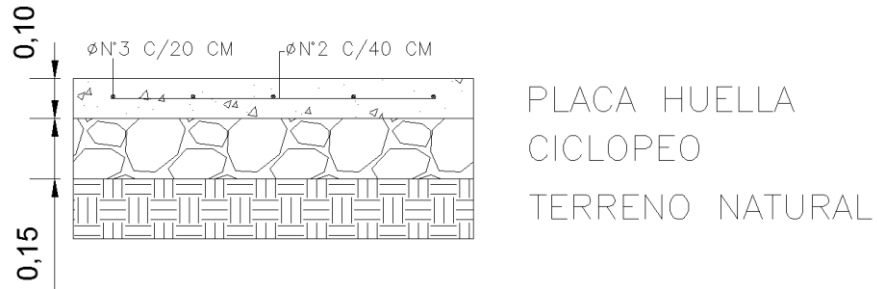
Acero de refuerzo para placas huella (tramo 2-3-4)
